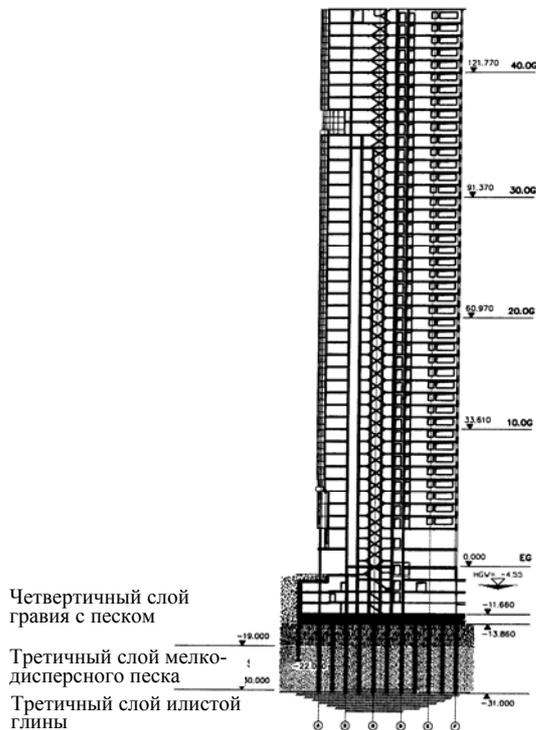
Поперечный разрез части основной конструкции 202-метровой башни Миллениум (Вена)
